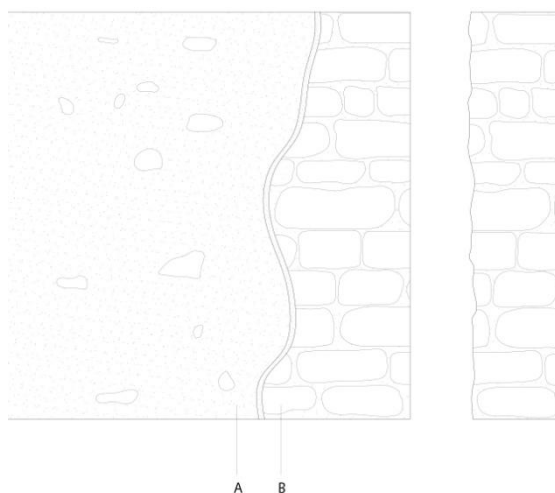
Vivienda en c/Maestro Serrano,13. Muro de mampostería.
